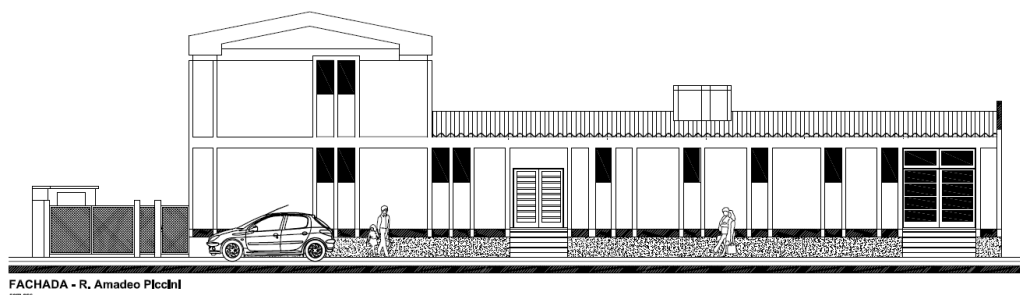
Fachada Oeste pintura somente primeiro pavimento, vista da cobertura a receber a pintura,
